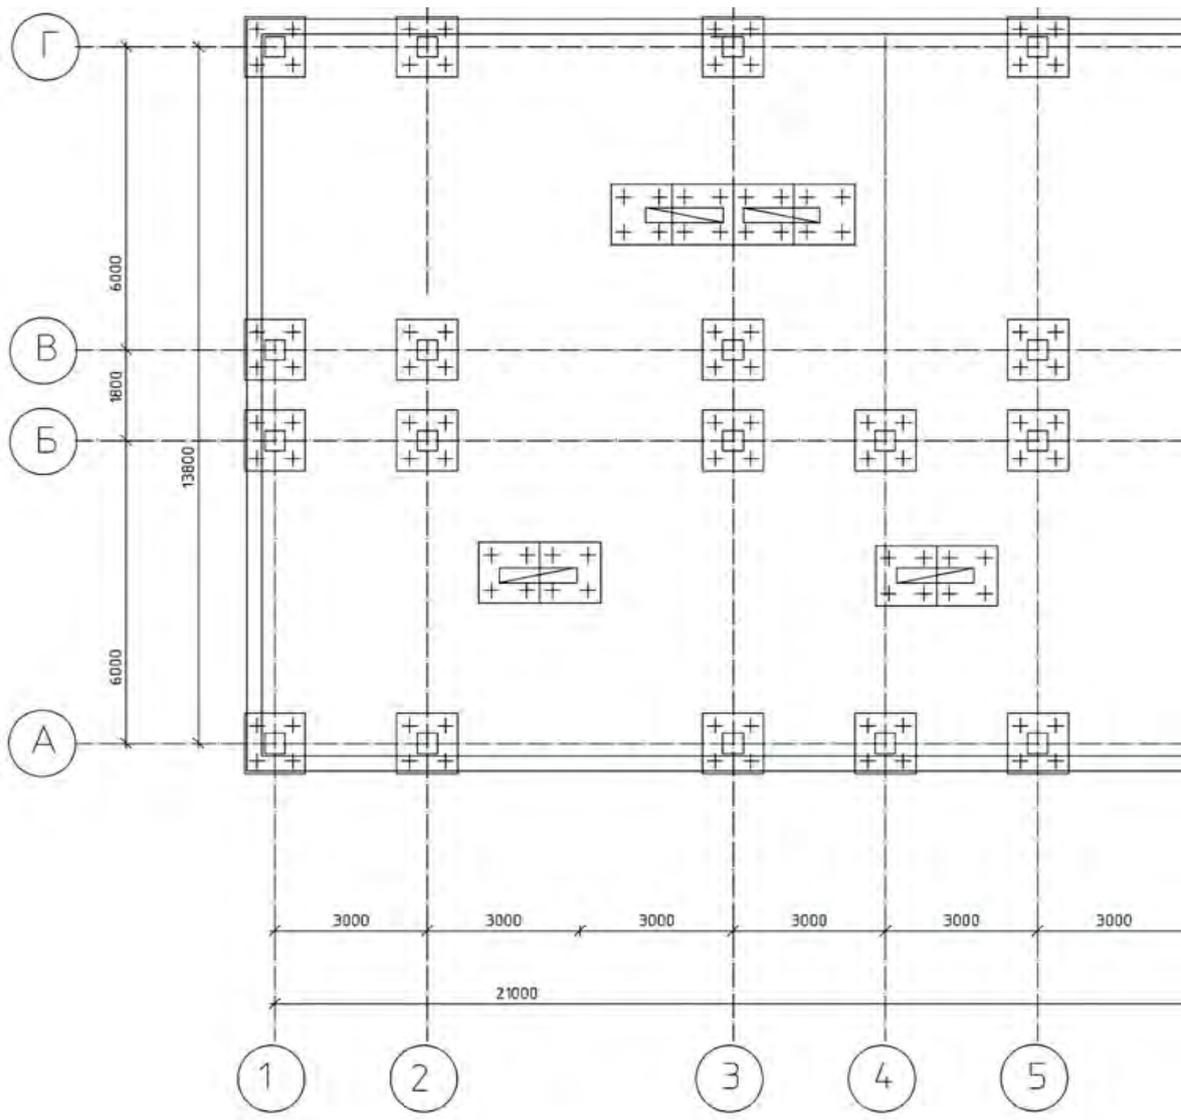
Фрагмент схемы расположения столбчатого фундамента на сваях для здания каркасного типа
